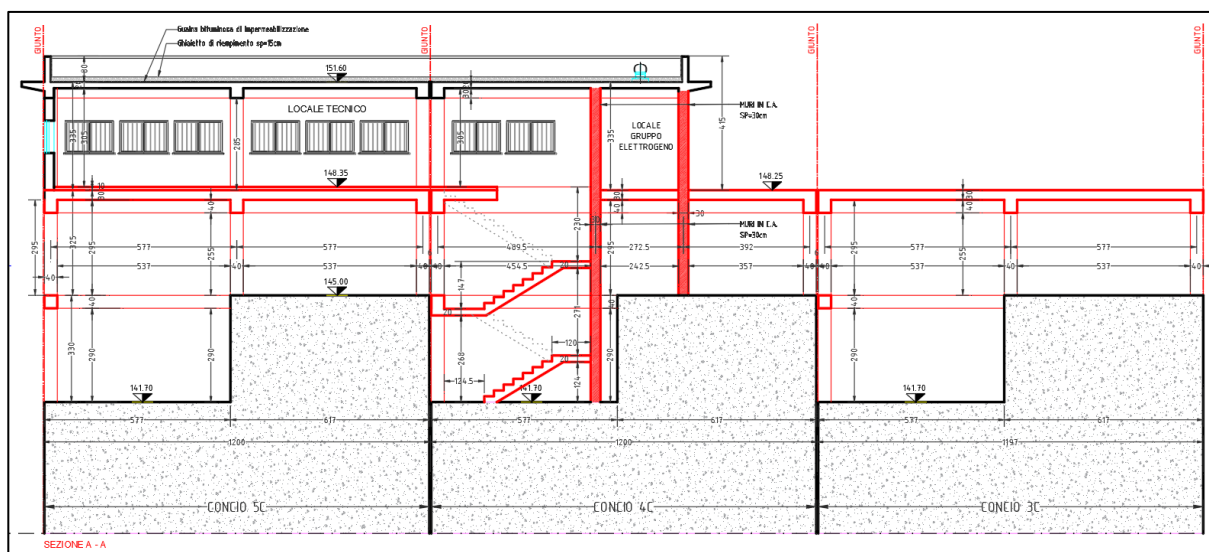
Sezione longitudinale del locale tecnico e della zona parcheggio
